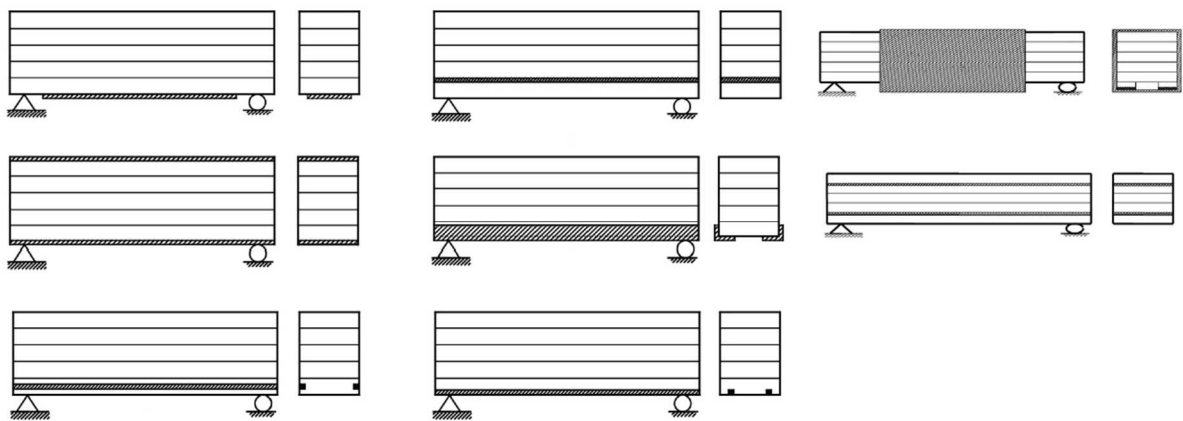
Tipos de vigas laminadas coladas utilizando fibras reforçadas com polímeros
